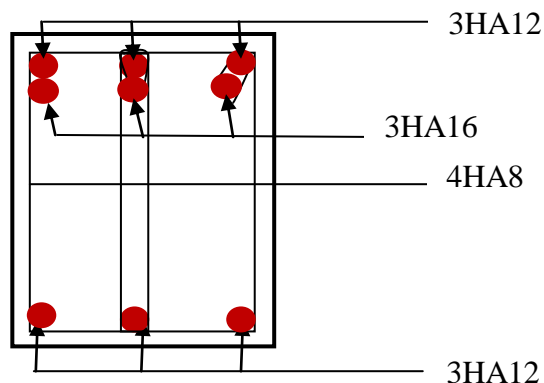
Ferrailage aux appuis d'une poutre secondaire.
